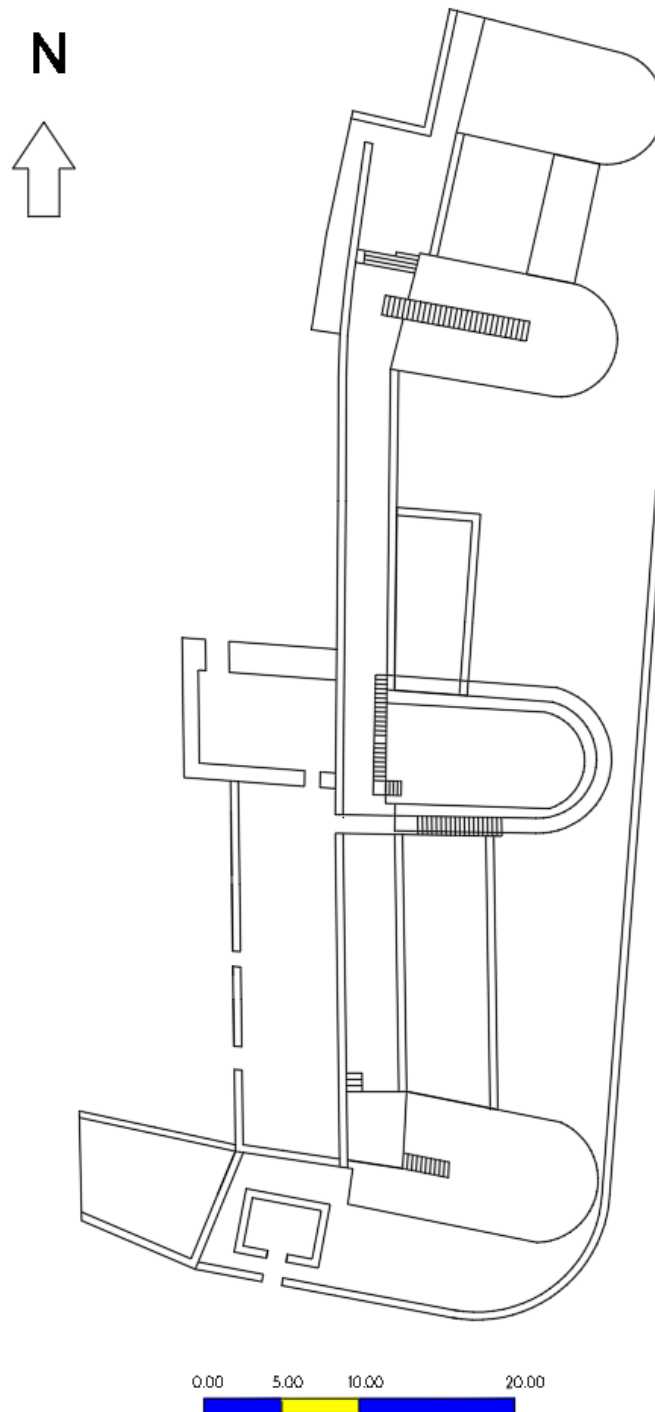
Planimetría Simón Cardozo Mamani, resultado de la integración de la planimetría figura 4.17 y la extracción de datos de los planos de las figuras 4.24, 4.25, 4.26 y 4.27.
